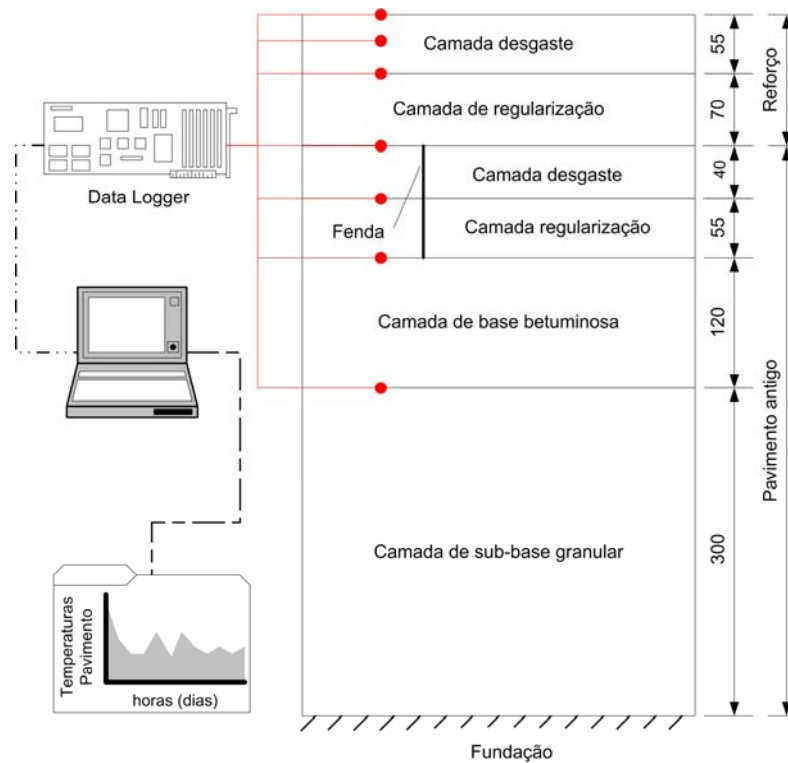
Identificação das camadas de pavimento e da colocação de termopares
